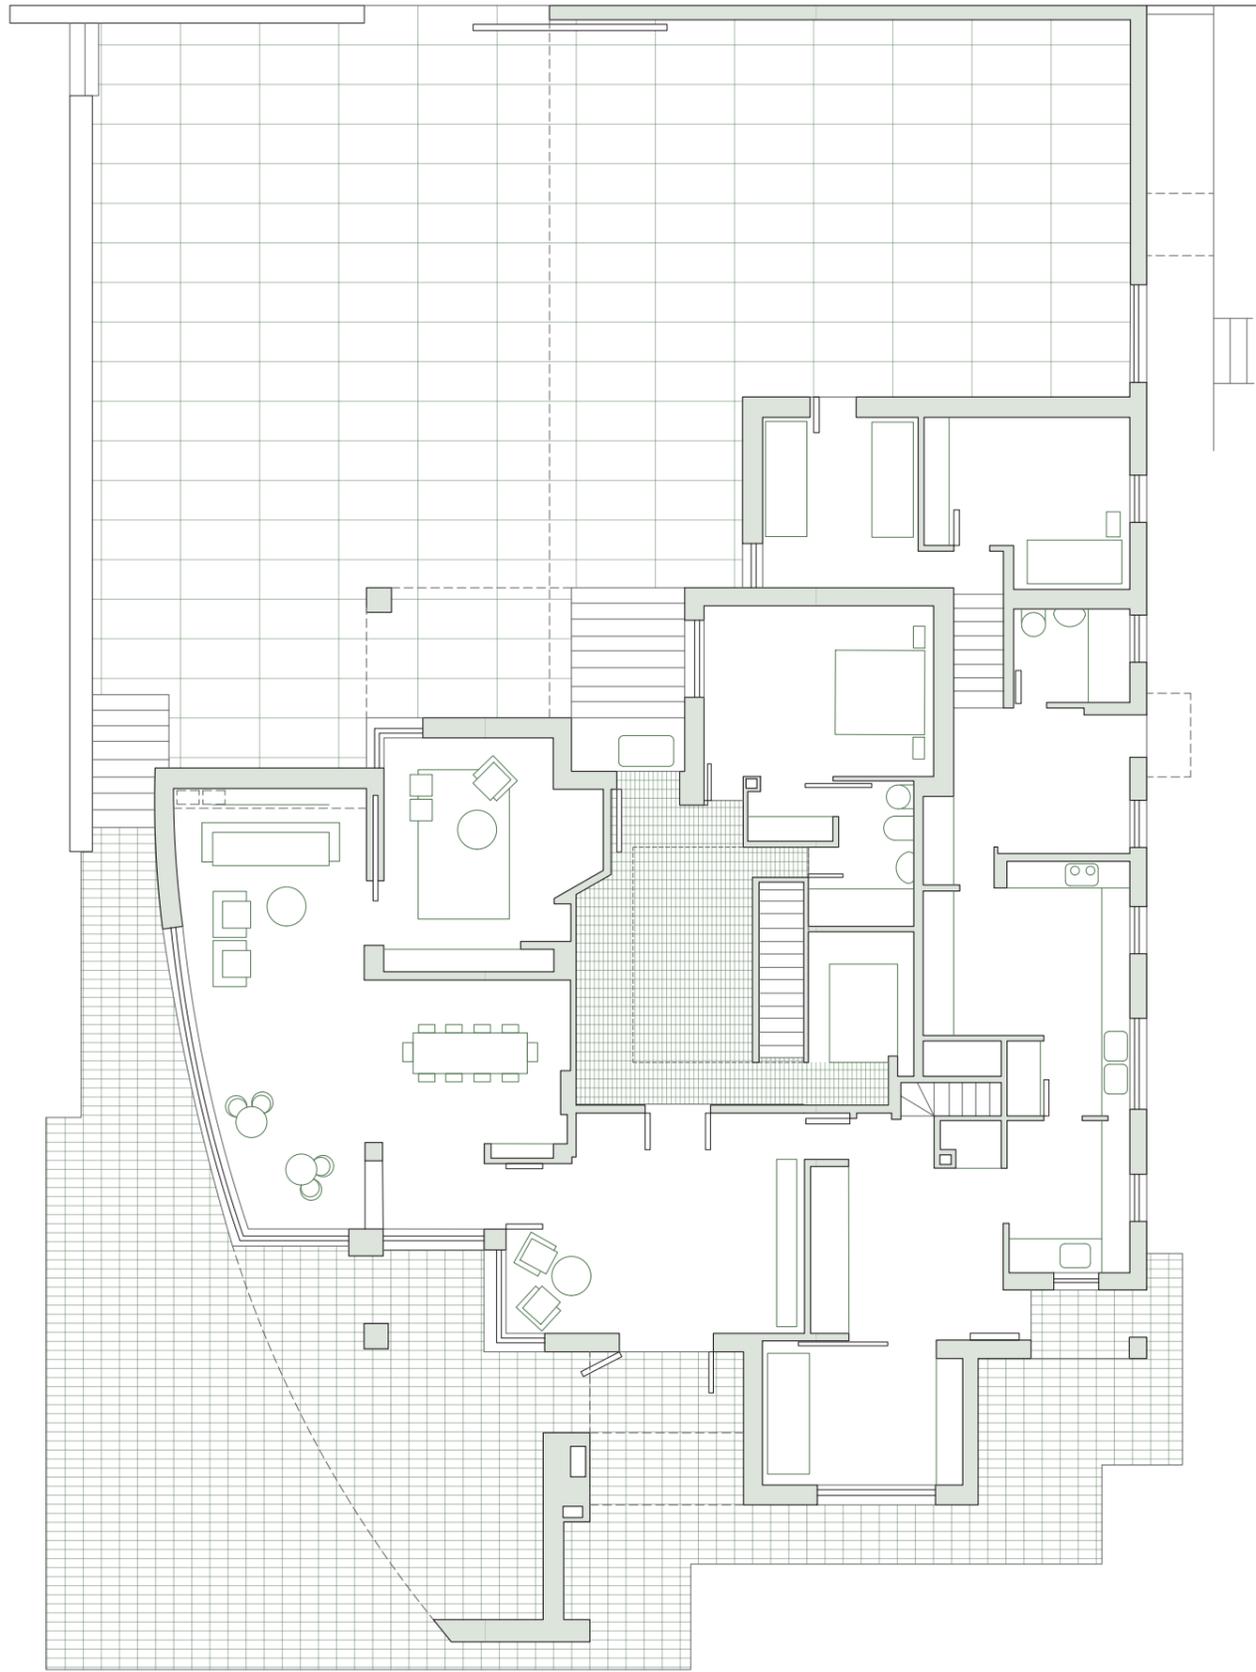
Planta baja, Casa Lirón de Robles. Escala 1:200
